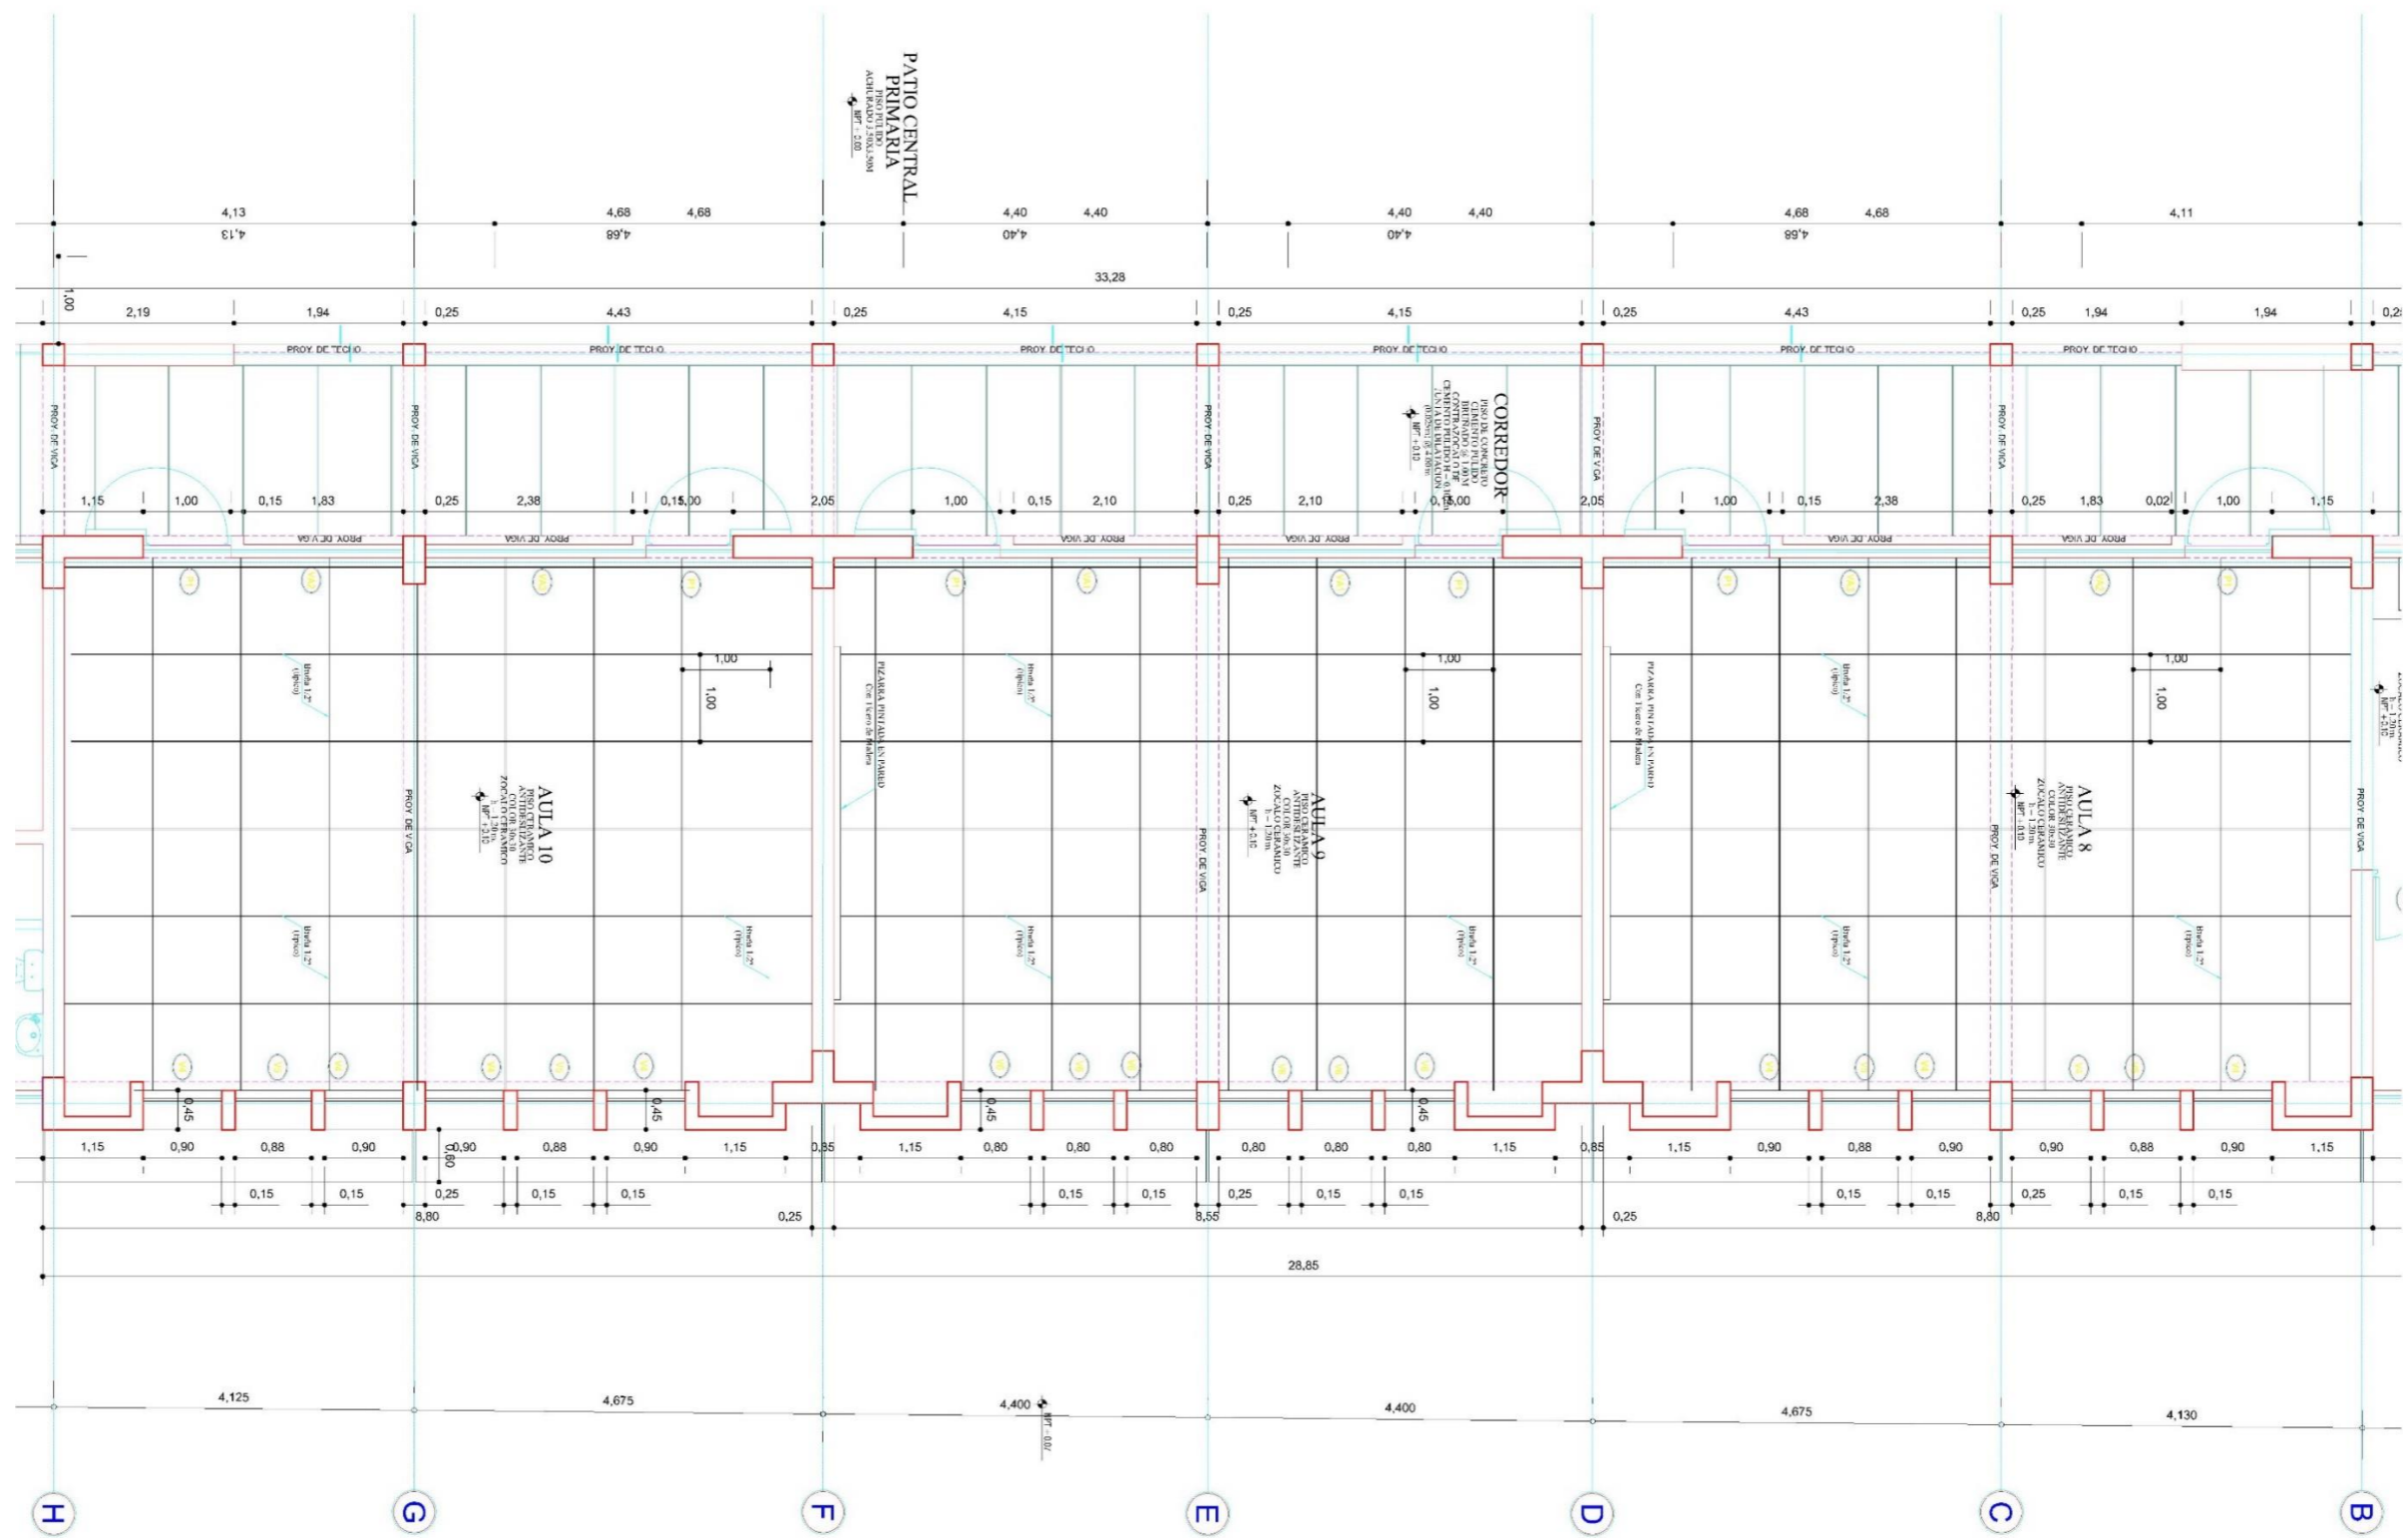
Planta Primer piso (Expediente técnico I.E N° 81703 E: 1/70).
